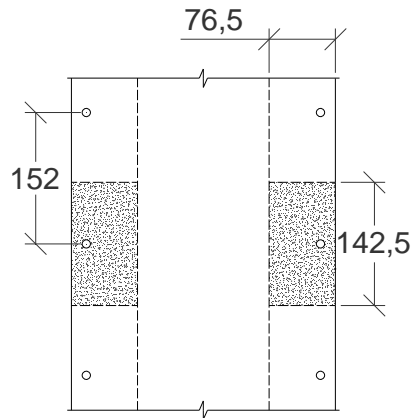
Sección longitudinal de la viga de ensayo CF1. Detalle de las áreas efectivas de la armadura pasiva transversal, según el criterio definido en el MC 1990. Cotas en mm.
